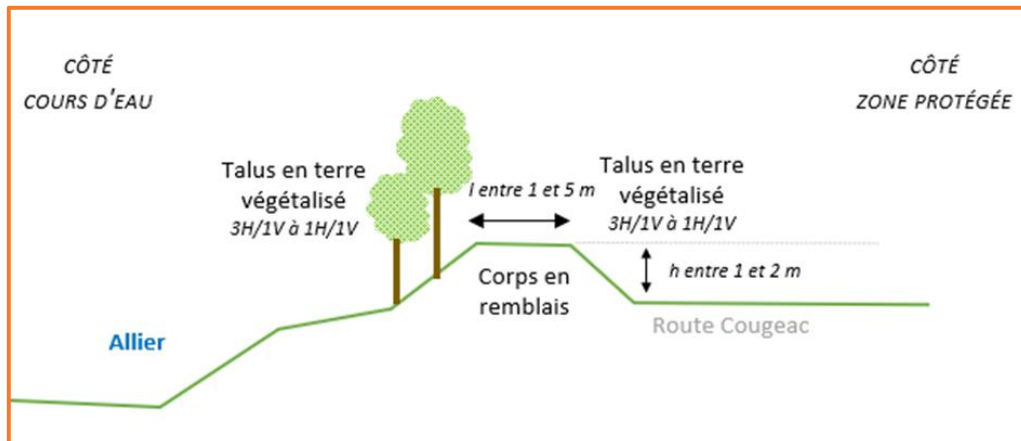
Coupe type du système d'endiguement de Lamothe – Tronçon 3 / Section b (T3b)
